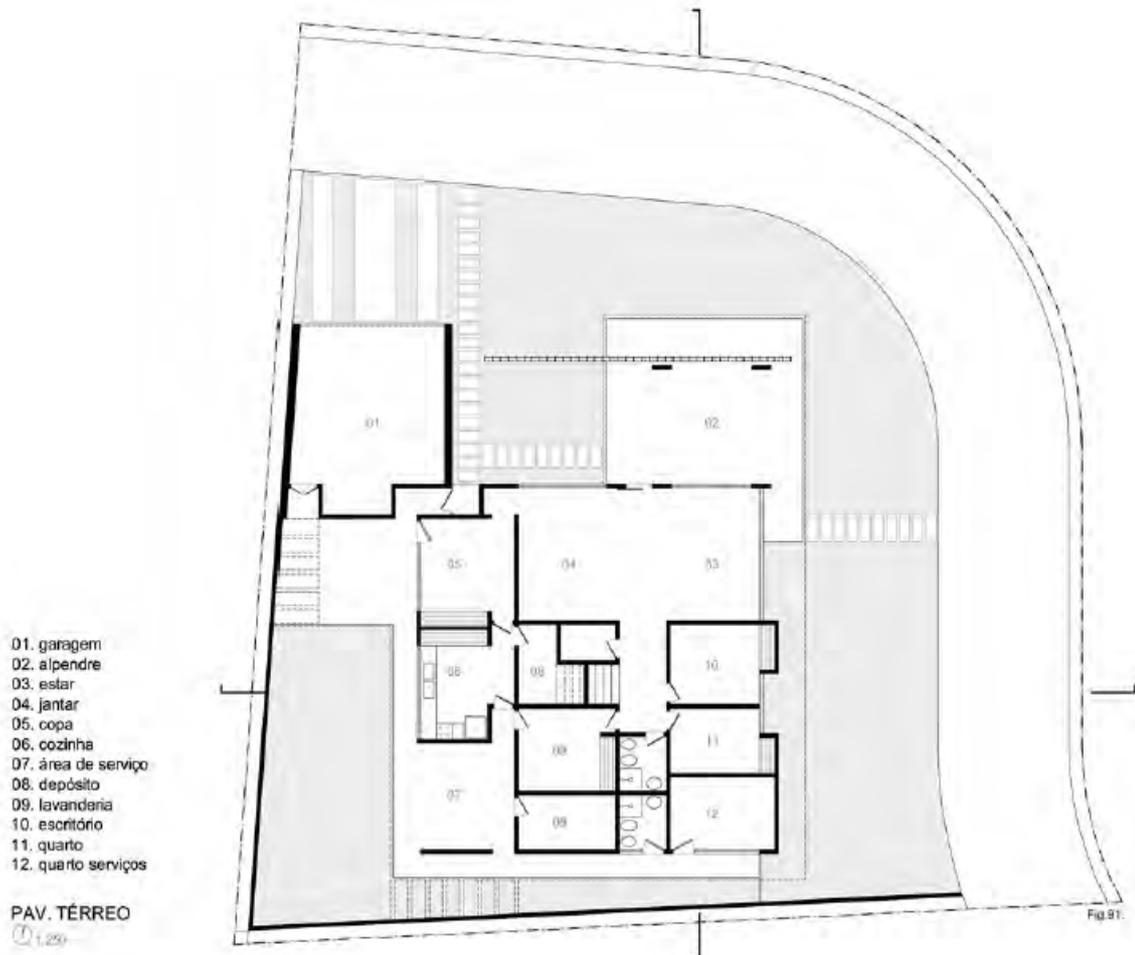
| PLANTA PAVIMENTO TÉRREO CASA CARLOS CUNHA FILHO, 1963 – ARQUITETOS SILAS VARIZO RODRIGUES E ARMANDO NORMAN. SILVA NETO, 2010, P. 106
